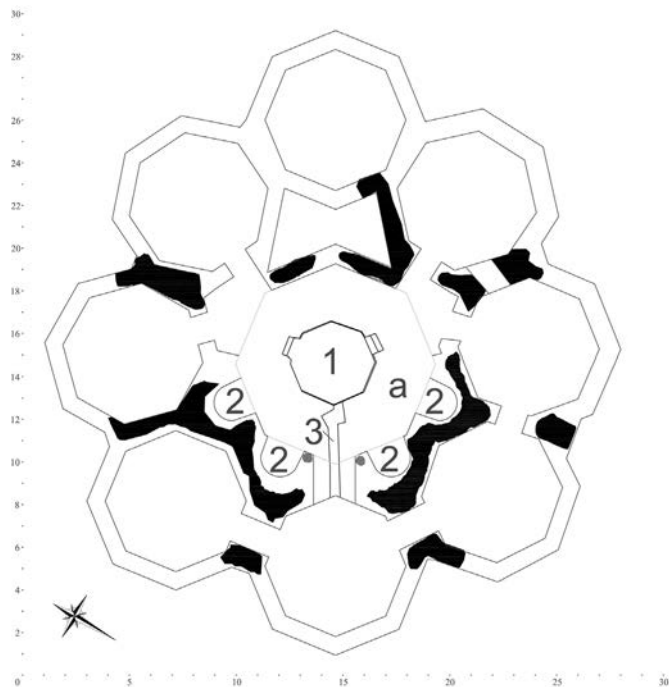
Términos de Las Bóvedas, reconstrucción esquemática de la planta con indicación de las características del ambiente central.
